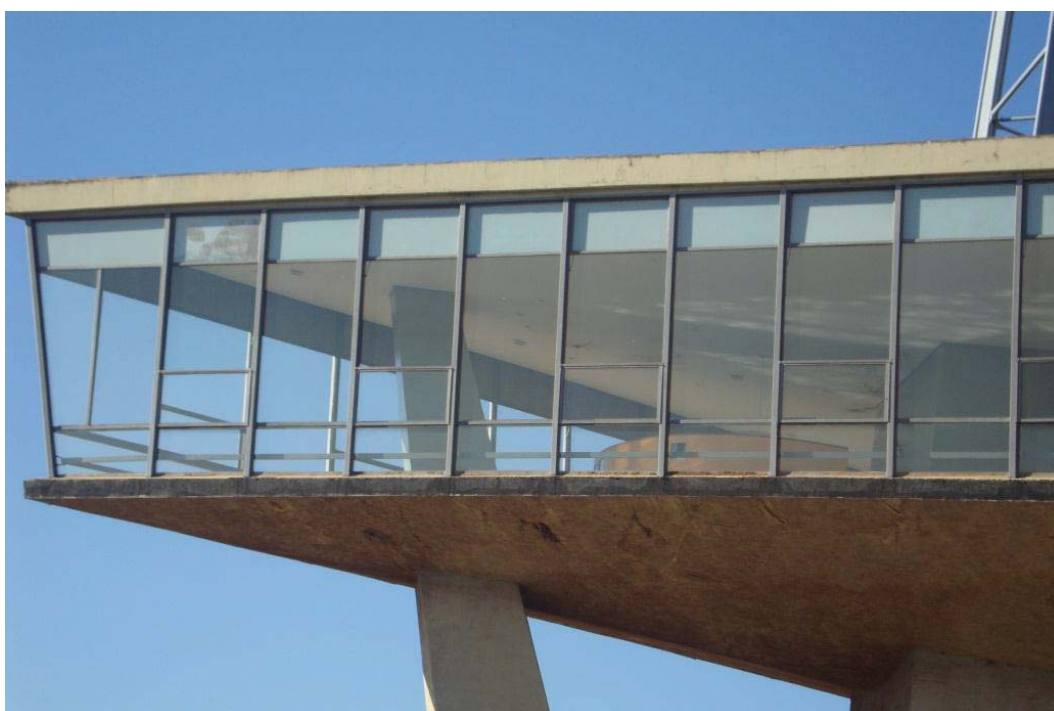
Vista do pilar de concreto no pavimento superior (Fonte: Autor)
